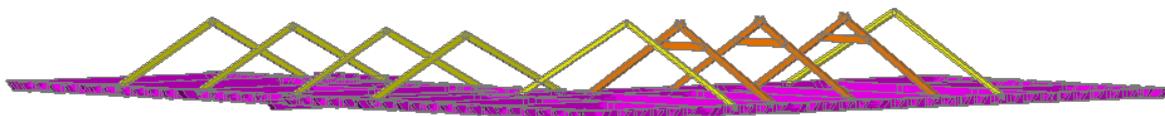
Representação 3D do telhado com as estruturas em asna e cangalha.
